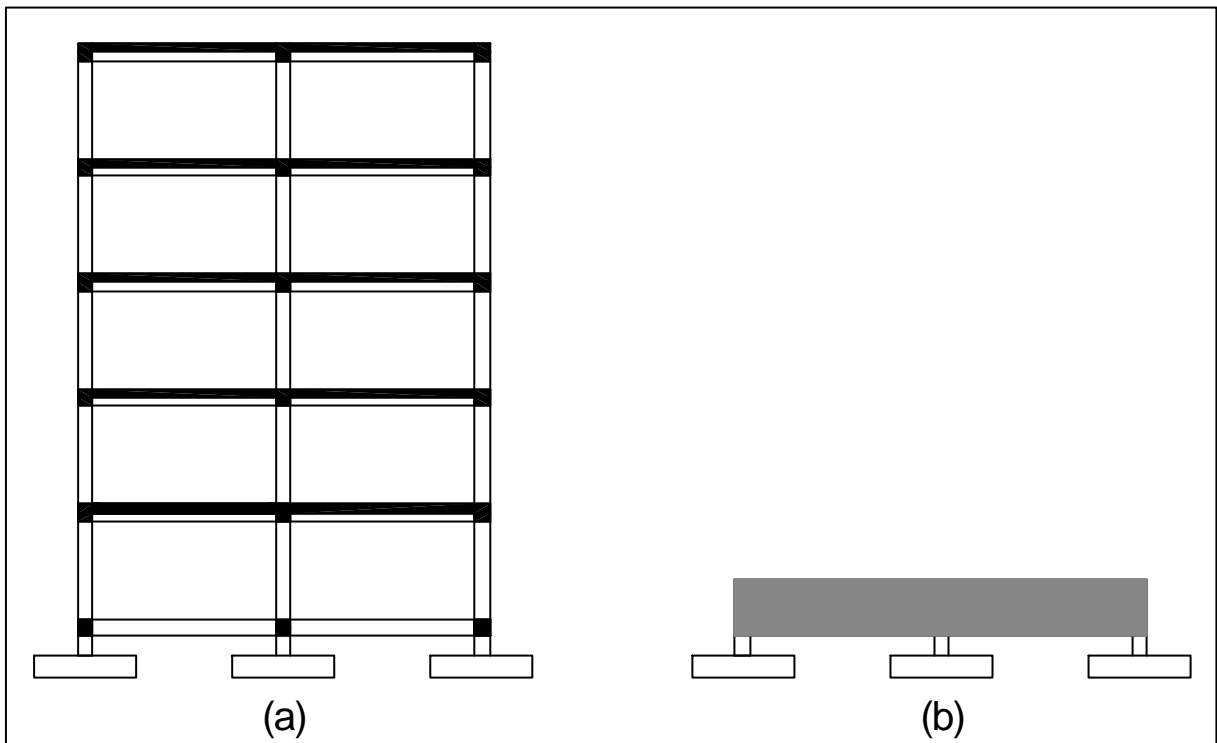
Conjunto constituído por (a) fundação e superestrutura e (b) fundação e viga equivalente.
